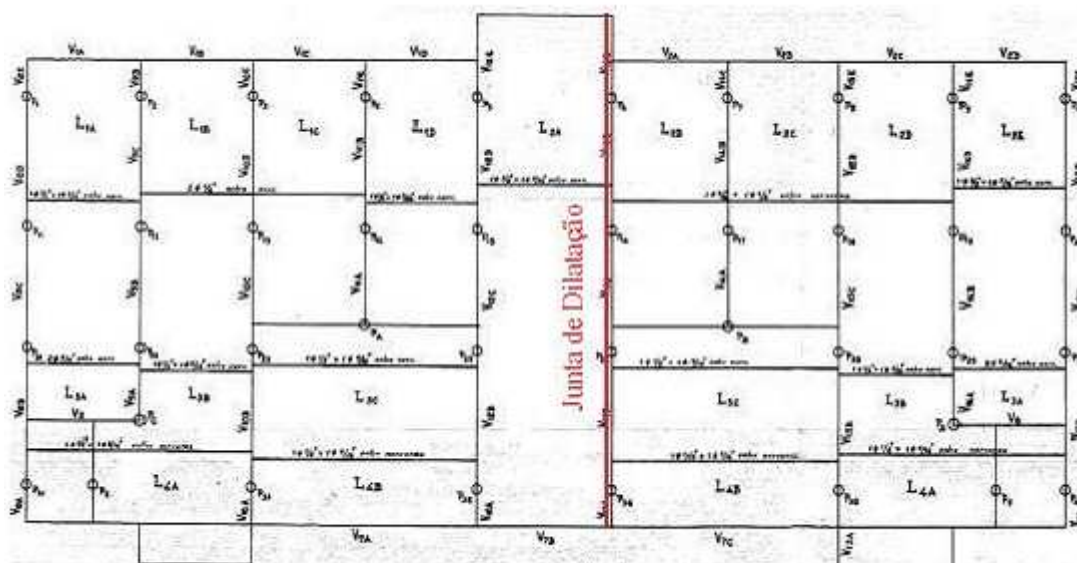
Planta estrutural do tecto tipo do edifício Costa Cabral (adaptado de Milheiro, 2008)
